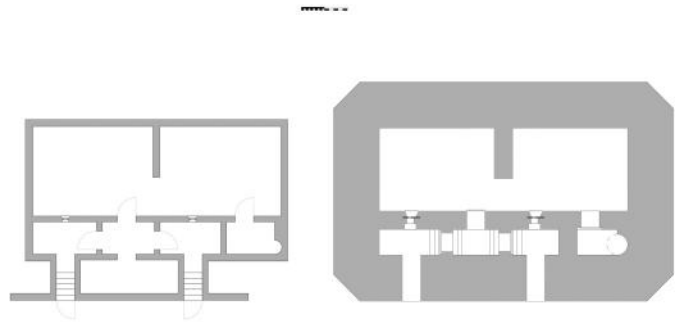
Grundriss und Regelbau 502 (Patrice Wijnands)
